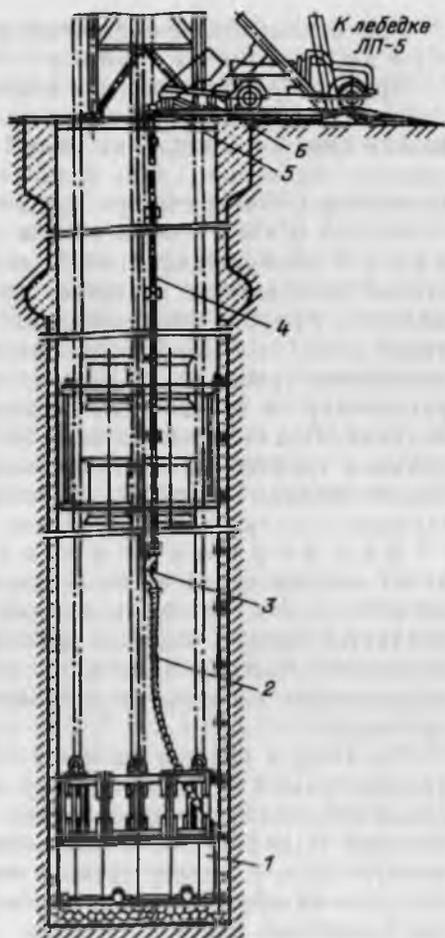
Схема размещения оборудования для возведения бетонной крепи:
